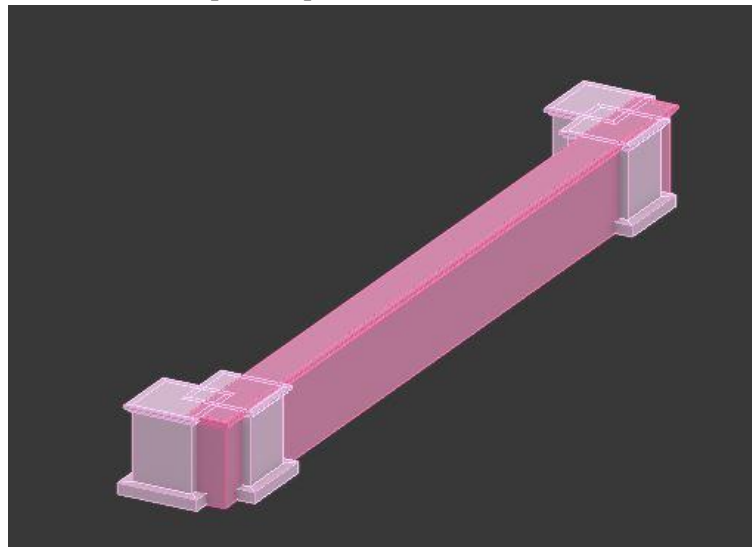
Detalle del tramo norte del antepecho de la azotea.
